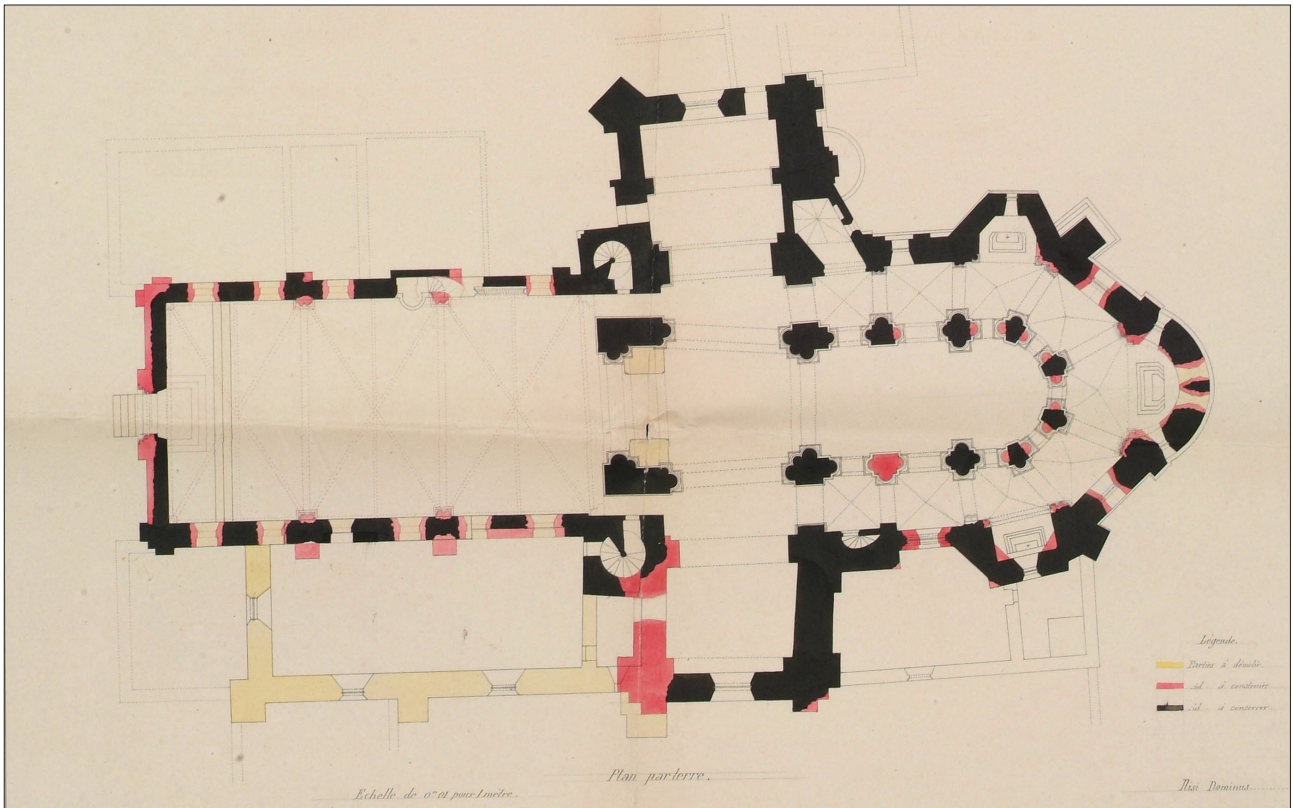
Projet de restauration de l'église de 1874 – AD37 20105_002 – Détail, plan de l'église
